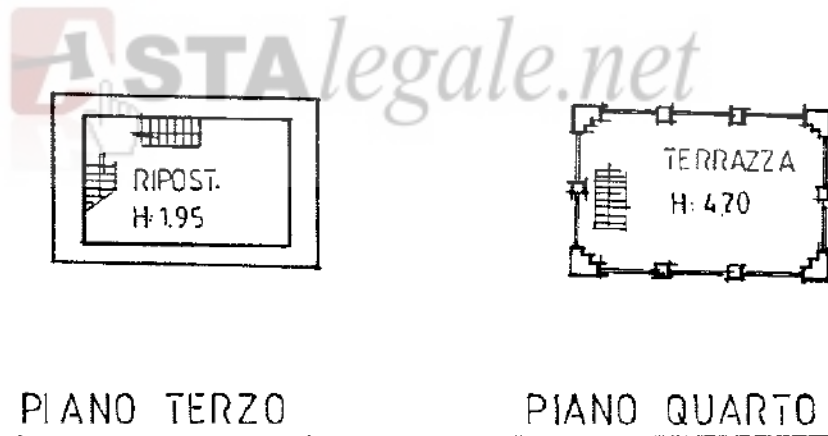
Estratto della planimetria catastale p.lla 415 (piano terzo e quarto).
